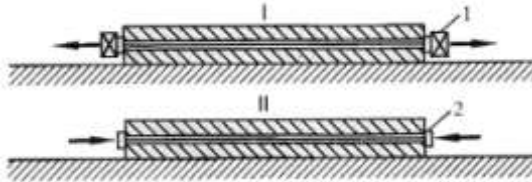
Схема создания предварительного натяжения арматуры на бетон
